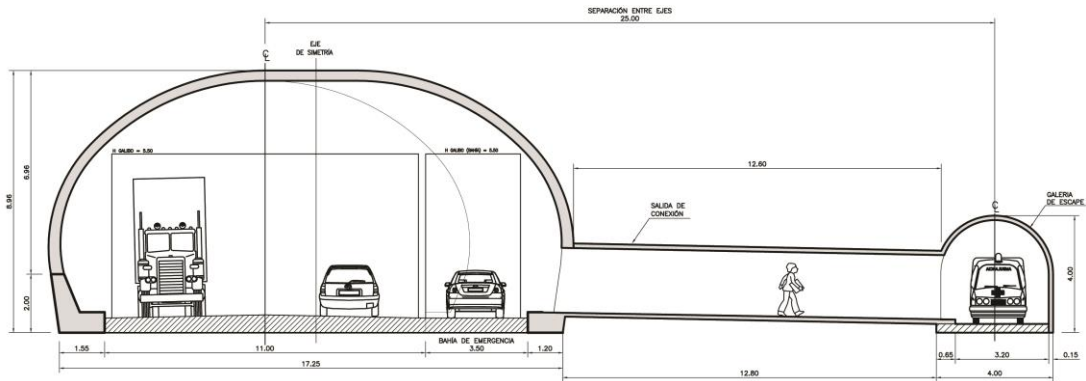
Galería de emergencia. Tomada del proyecto Carretera Durango-Mazatlán, México.
